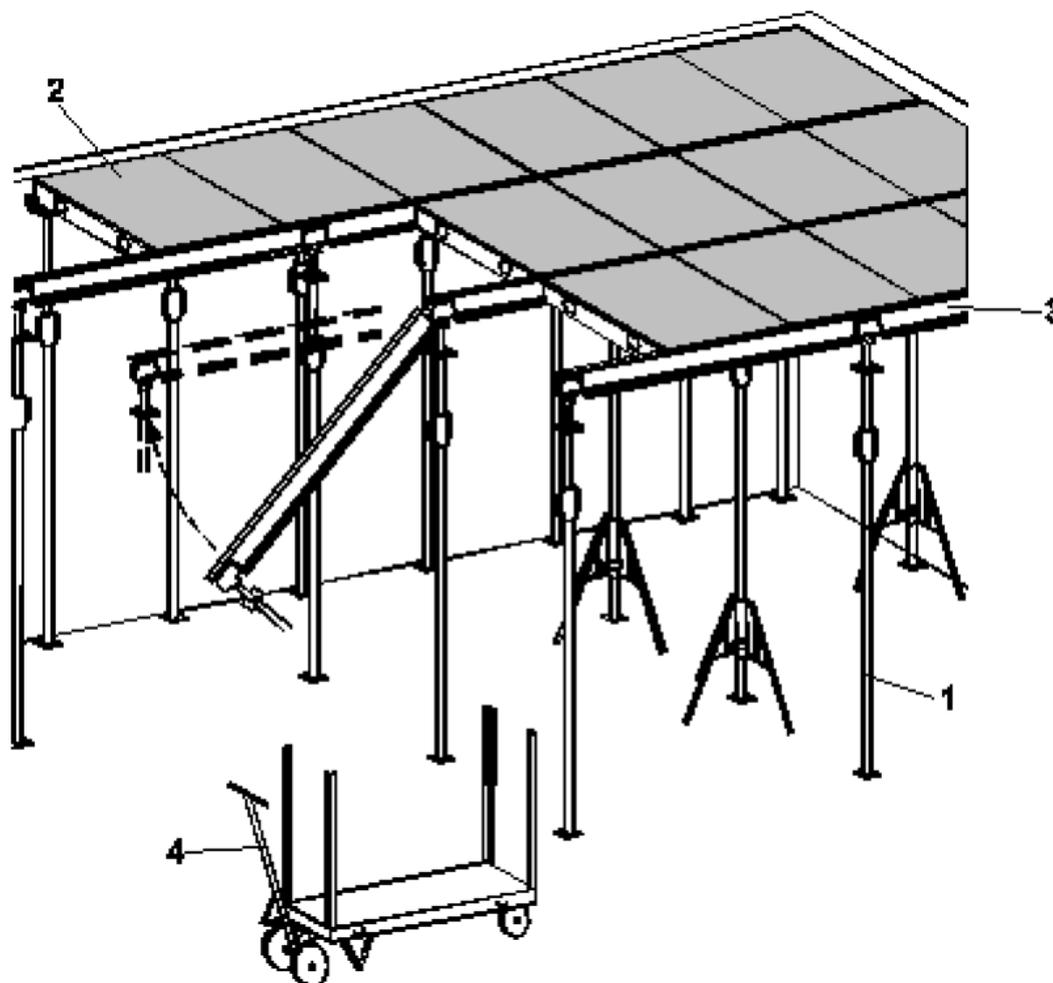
Схема опалубки перекрытий на основе телескопических стоек с падающими головками 1 — телескопическая стойка с падающей головкой; 2 — щит опалубки перекрытий; 3 — продольная балка; 4 — тележка для транспортирования щитов опалубки перекрытий
